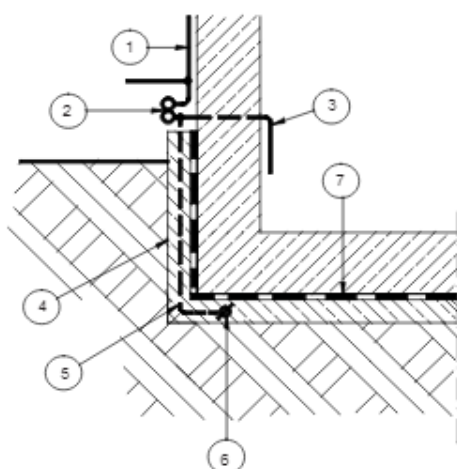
Fondazione Isolata con dispersore di fondazione nello strato di calcestruzzo non armato sotto l'impermeabilizzazione
